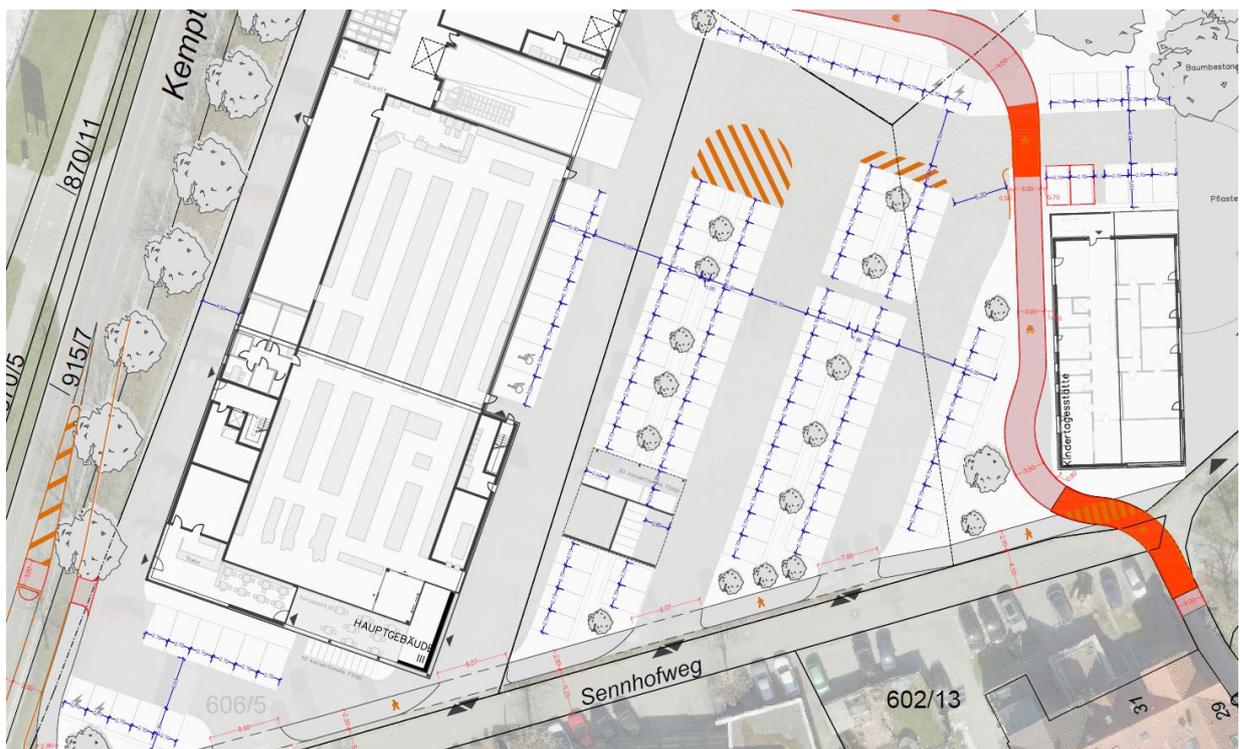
Prüfung Parkierungsanlage, (Architekturplan/BuP)
